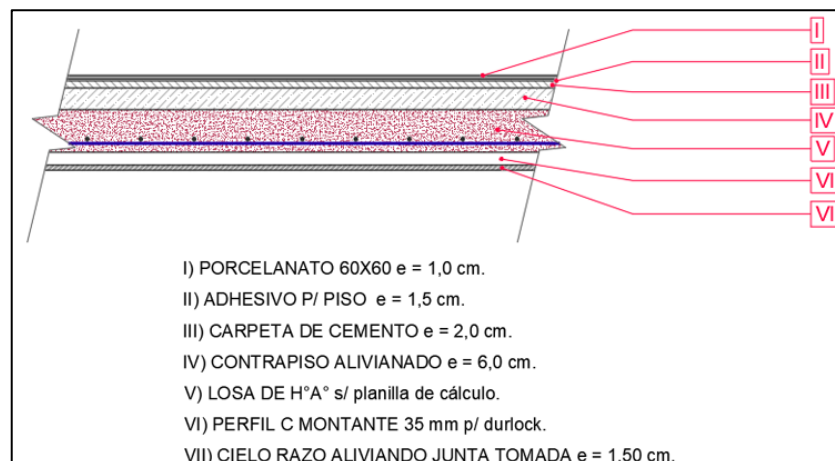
Paquete estructural de planta tipo e=12cm.
